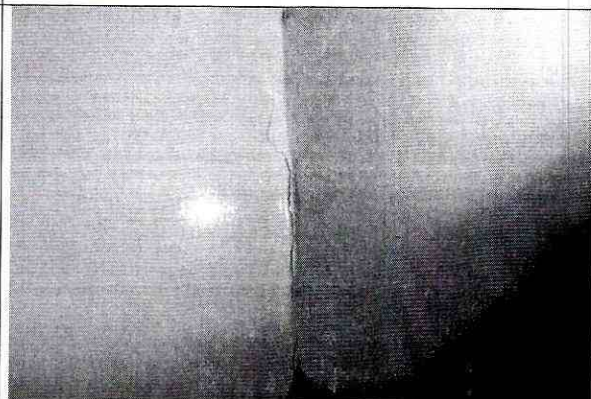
Fisura en vértice de muros del segundo nivel, costado norte.
